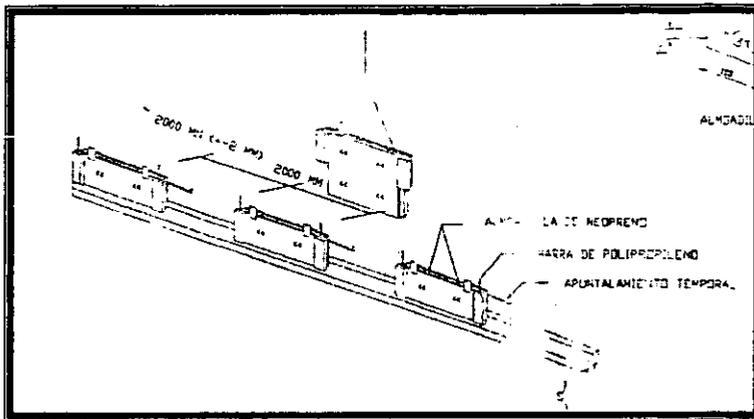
Montaje de panel tipo Q4 entre dos paneles tipo C2.
